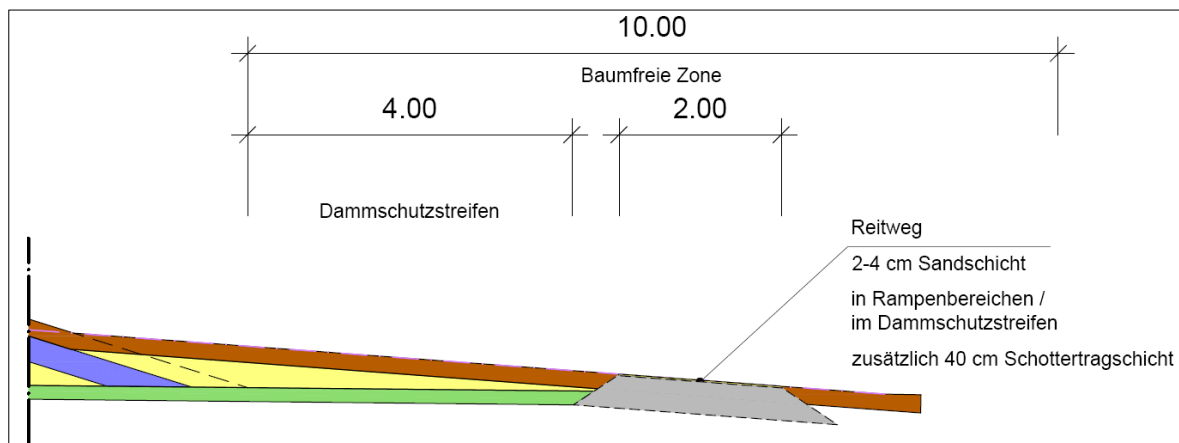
Regelprofil wasserseitige Unterhaltungsberme (Ausschnitte der Plandarstellung)
